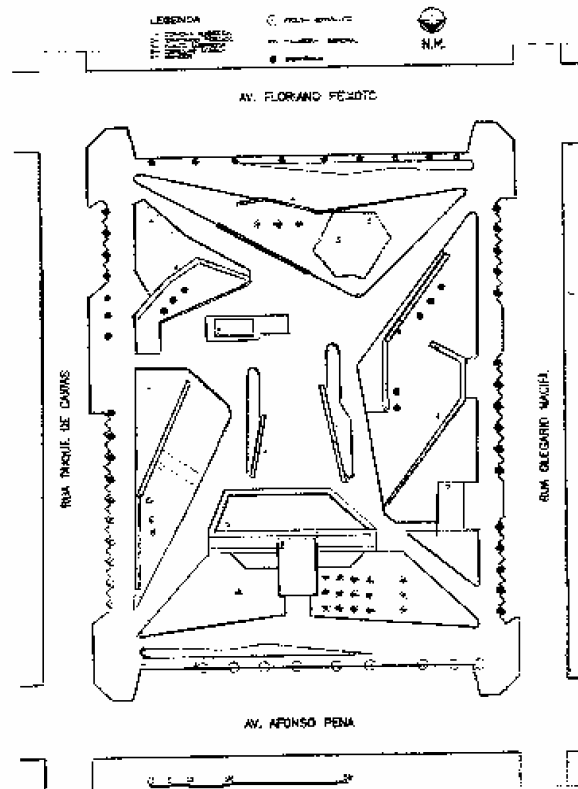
Planta Praça Tubal Vilela década de 1960.<sup>69</sup>
